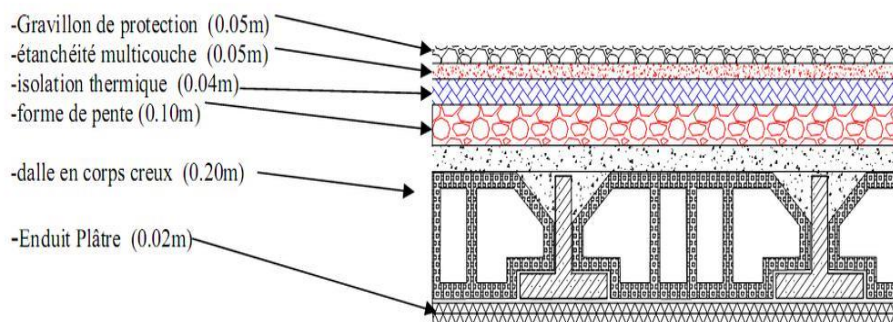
Coupe verticale du plancher terrasse inaccessible
